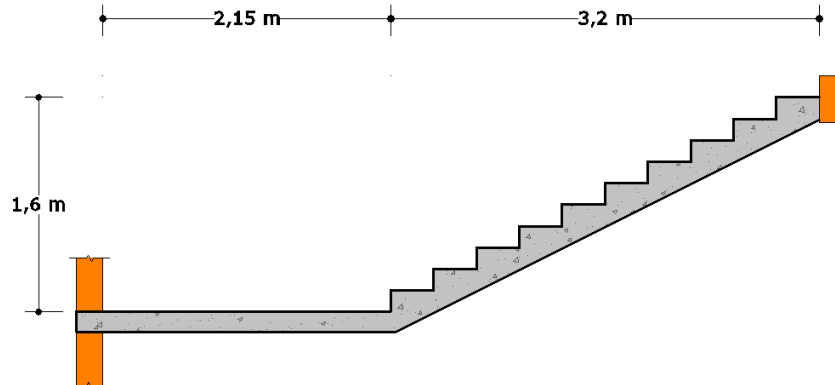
Tercer Tramo Escalera; Elaboracion Propia
